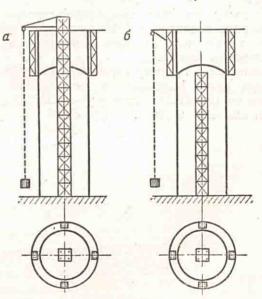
Схема подвижных форм для возведения железобетонных цилиндрических водонапорных башен:
